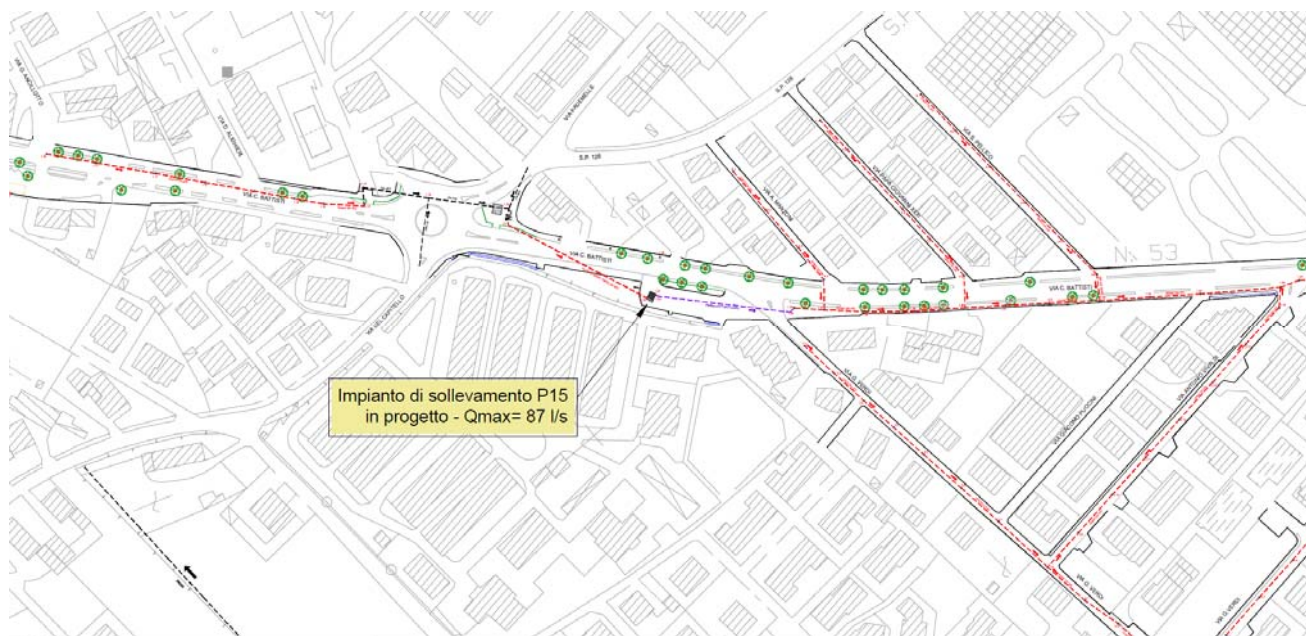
Planimetria della rete di progetto – Stralcio parte Ovest
